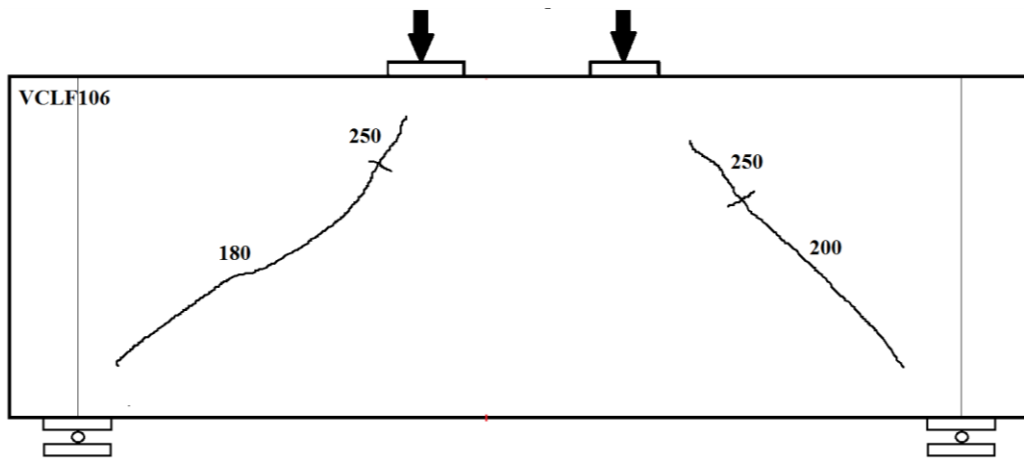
Esquema de fissuração da viga VCLF106.
